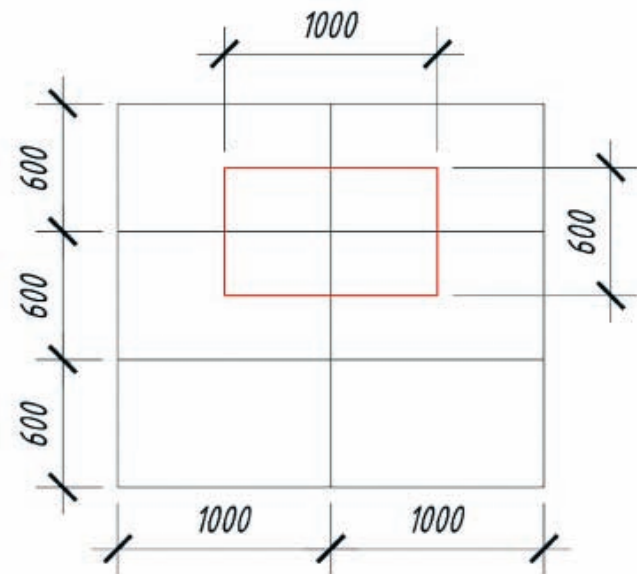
Схема расчётного фрагмента однослойного утепления фасада
